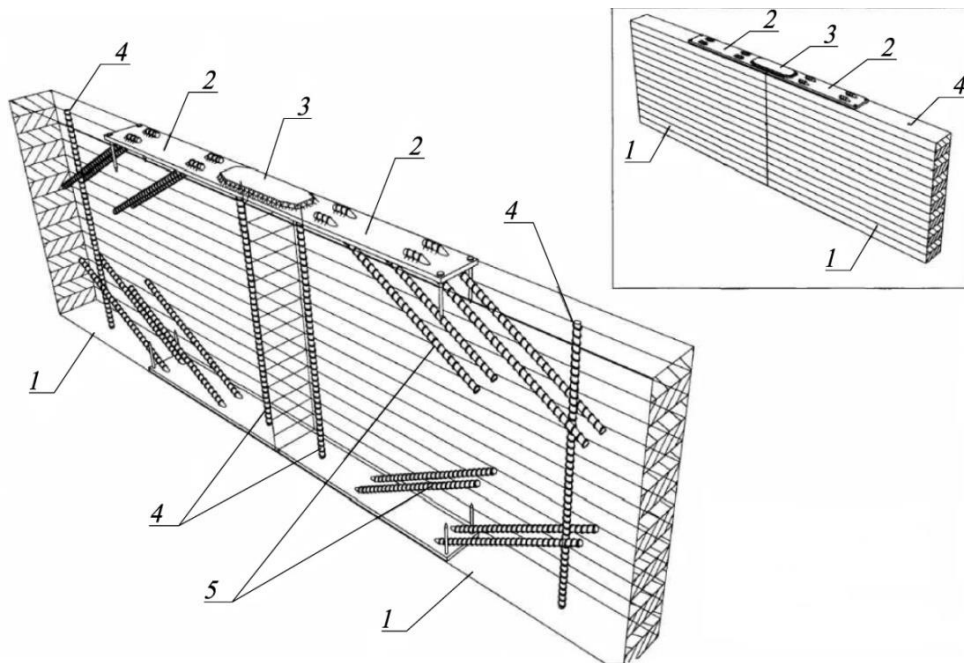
Растянутый стык на клеенных стержнях по «системе ЦНИИСК»: 1 - основные стыкуемые элементы; 2 - накладки из полосовой стали; 3 - монтажные накладки на сварке; 4 - арматурные стержни, клеенные поперек волокон; 5 - клеенные наклонные арматурные стержни под углом  $30^\circ - 45^\circ$
